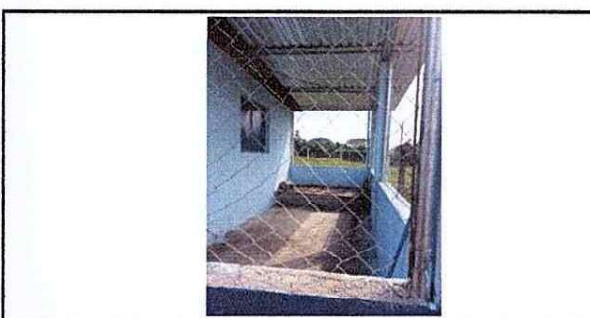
levantamiento de muro y maya, cernido y pintado en corredor de cocina
